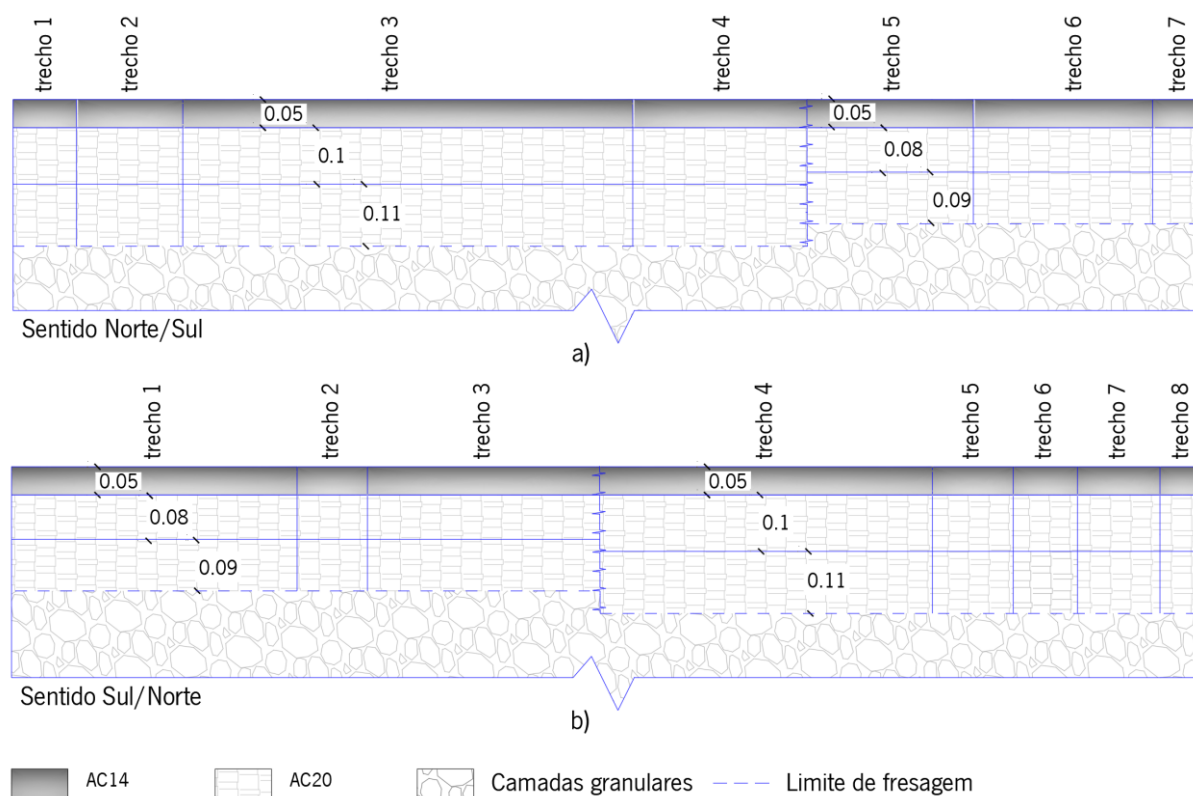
Esquema em perfil longitudinal para a solução de substituição integral das camadas betuminosas existentes:
